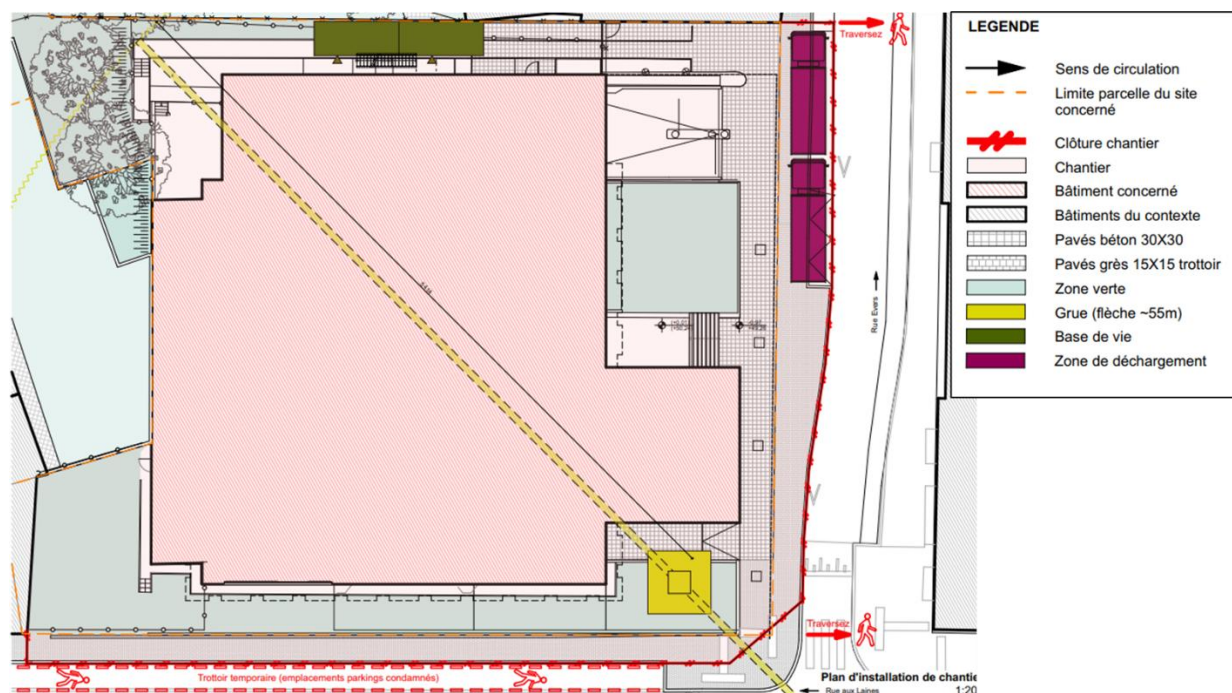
Plan d'implantation de chantier probable (source : Baumans-Deffet)
